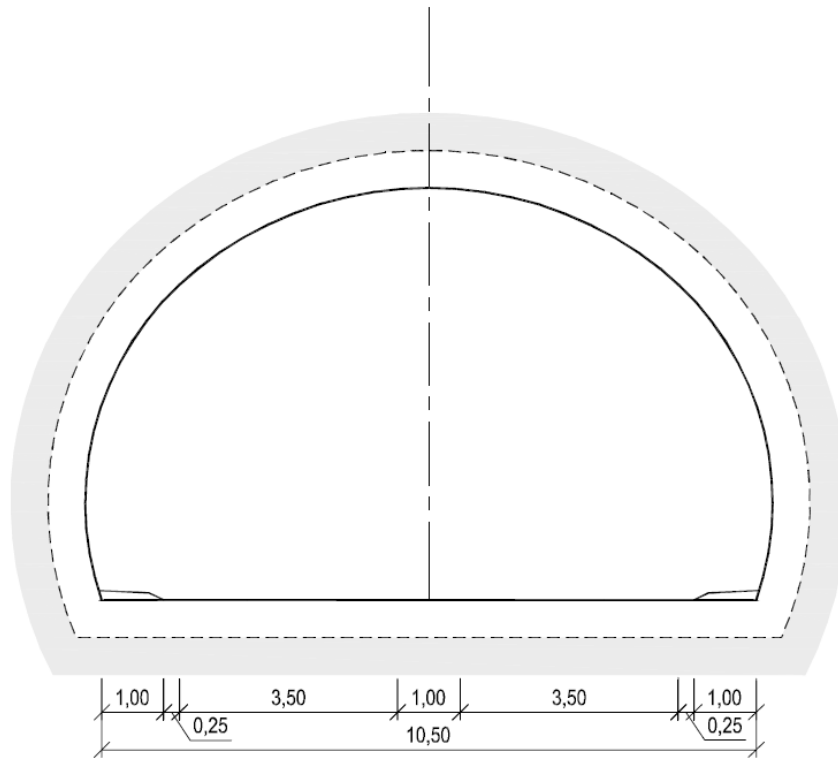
Tunnelprofil T9,5 (mål i m)
